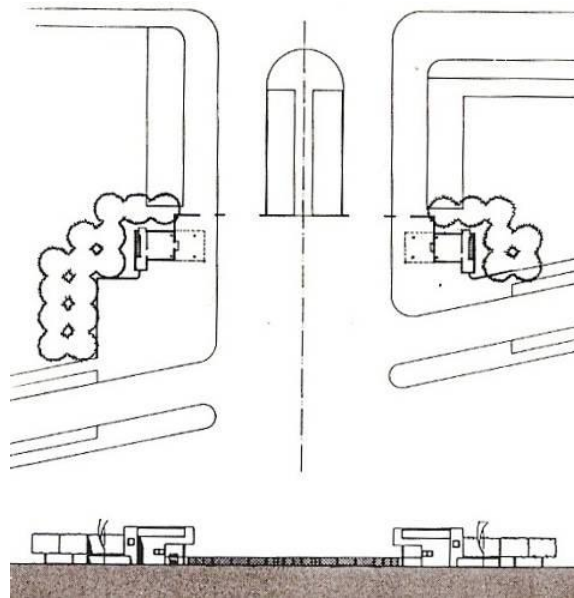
Lageplan und Ansicht der Torgebäude der 45. Straße.
